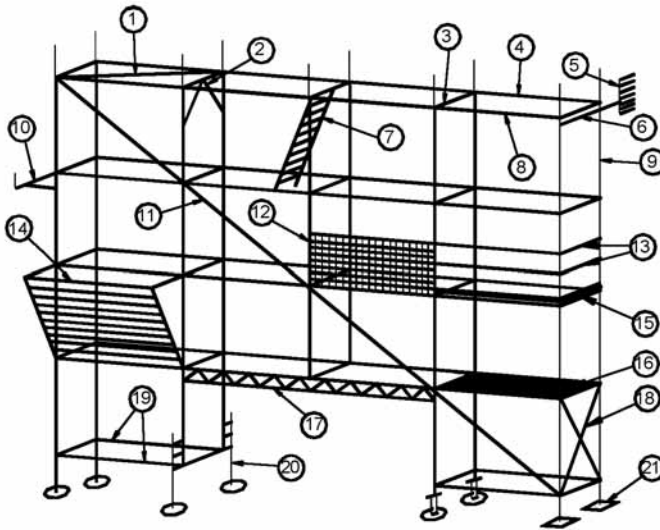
Nomenclatura degli elementi principali di un ponteggio: 1) diagonale in pianta, 2) rinforzo telaio, 3) collegamento trasversale, 4) corrente posteriore, 5) aggancio, 6) collegamento, 7) scaletta, 8) traverso, 9) montante, 10) apparecchio sollevatore, 11) diagonale di facciata, 12) graticcio di protezione, 13) doppio parapetto, 14) mantovana o parasassi, 15) fermapiEDE, 16) impalcato, 17) trave passo-carraia, 18) rinforzo al primo livello, 19) rinforzo alla base, 20) pezzo speciale, 21) basetta fissa o regolabile.
